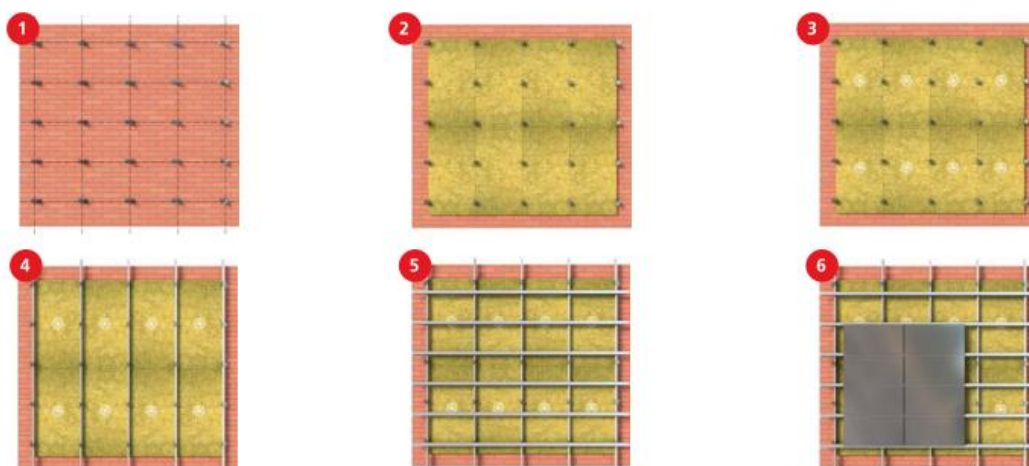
Instalación de la fachada ventilada. Fuente: Rockwool.es (2014)
